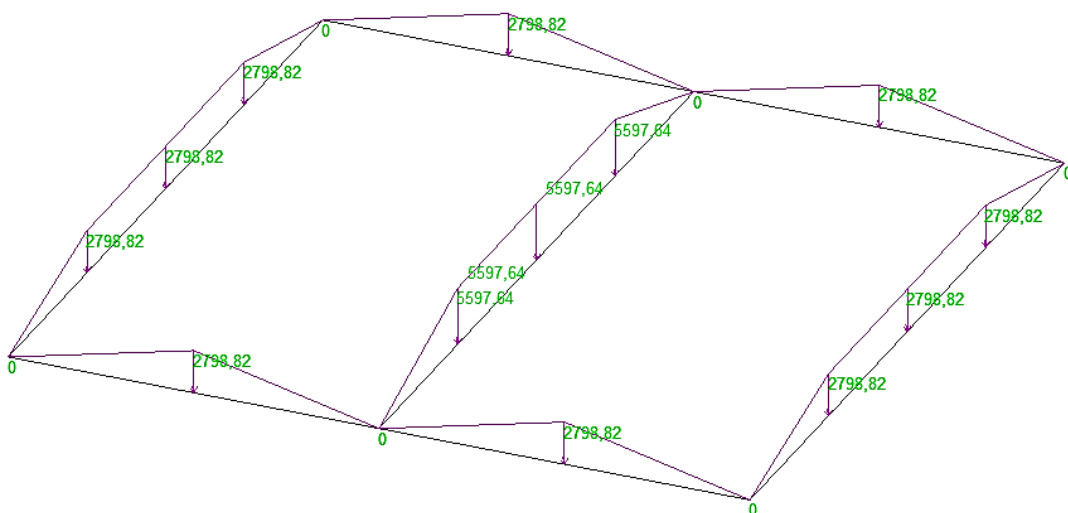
Распределение линейных нагрузок, собранных с кровли-террасы. Правила формирования нагрузок аналогичны правилам для перекрытия
